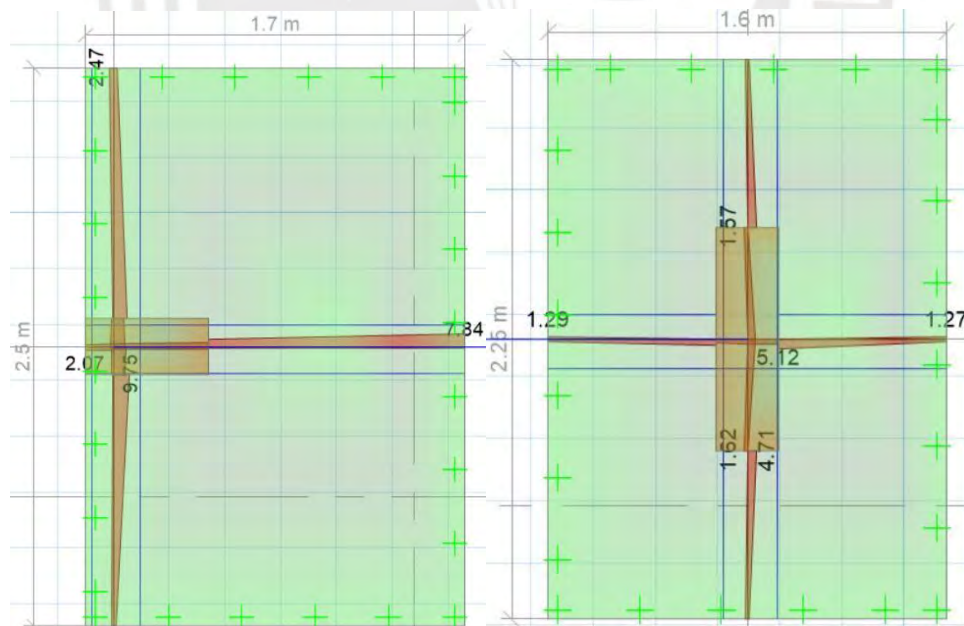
9. Zapatas conectadas – Acero requerido (cm2)
